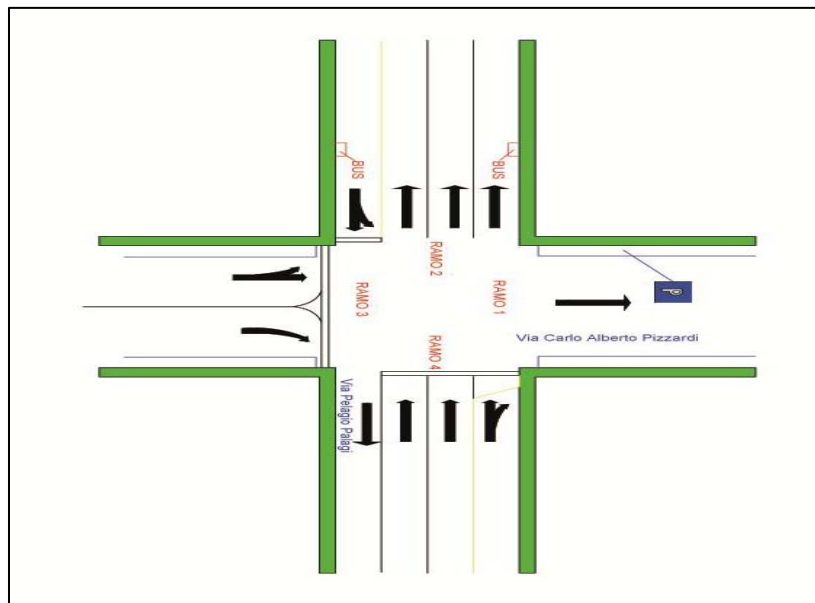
Schema strutturale intersezione Palagi-Pizzardi
